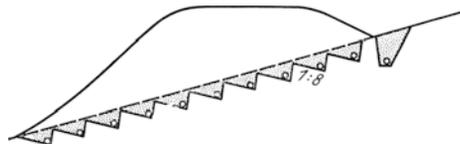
Sicherung des Dammfußes bei geneigtem Gelände durch Verzahnungen mit dem Untergrund.
